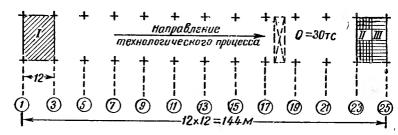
Принципиальная схема планировки унифицированного типового пролета УТП-1 для производства сборного железобетона
